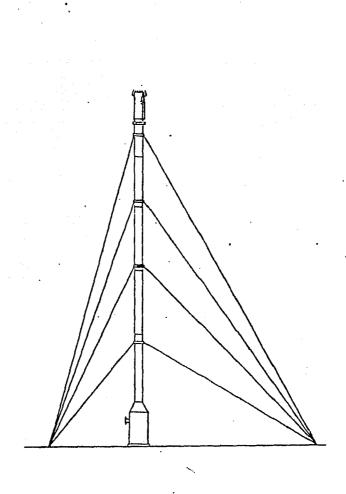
QUEMADOR ELEVADO CABLEADO
